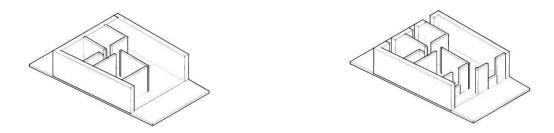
División en bahareque y ventilación e iluminación de la vivienda
